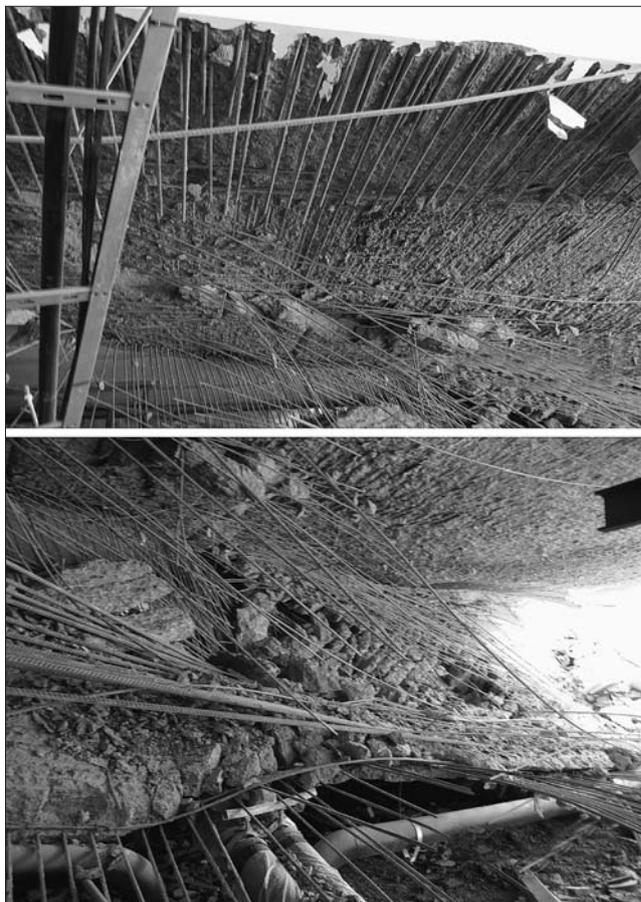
Характер разрушения безбалочной, бескапитальной железобетонной монолитной плиты перекрытия с вязаной арматурой при аварийных нагрузках
